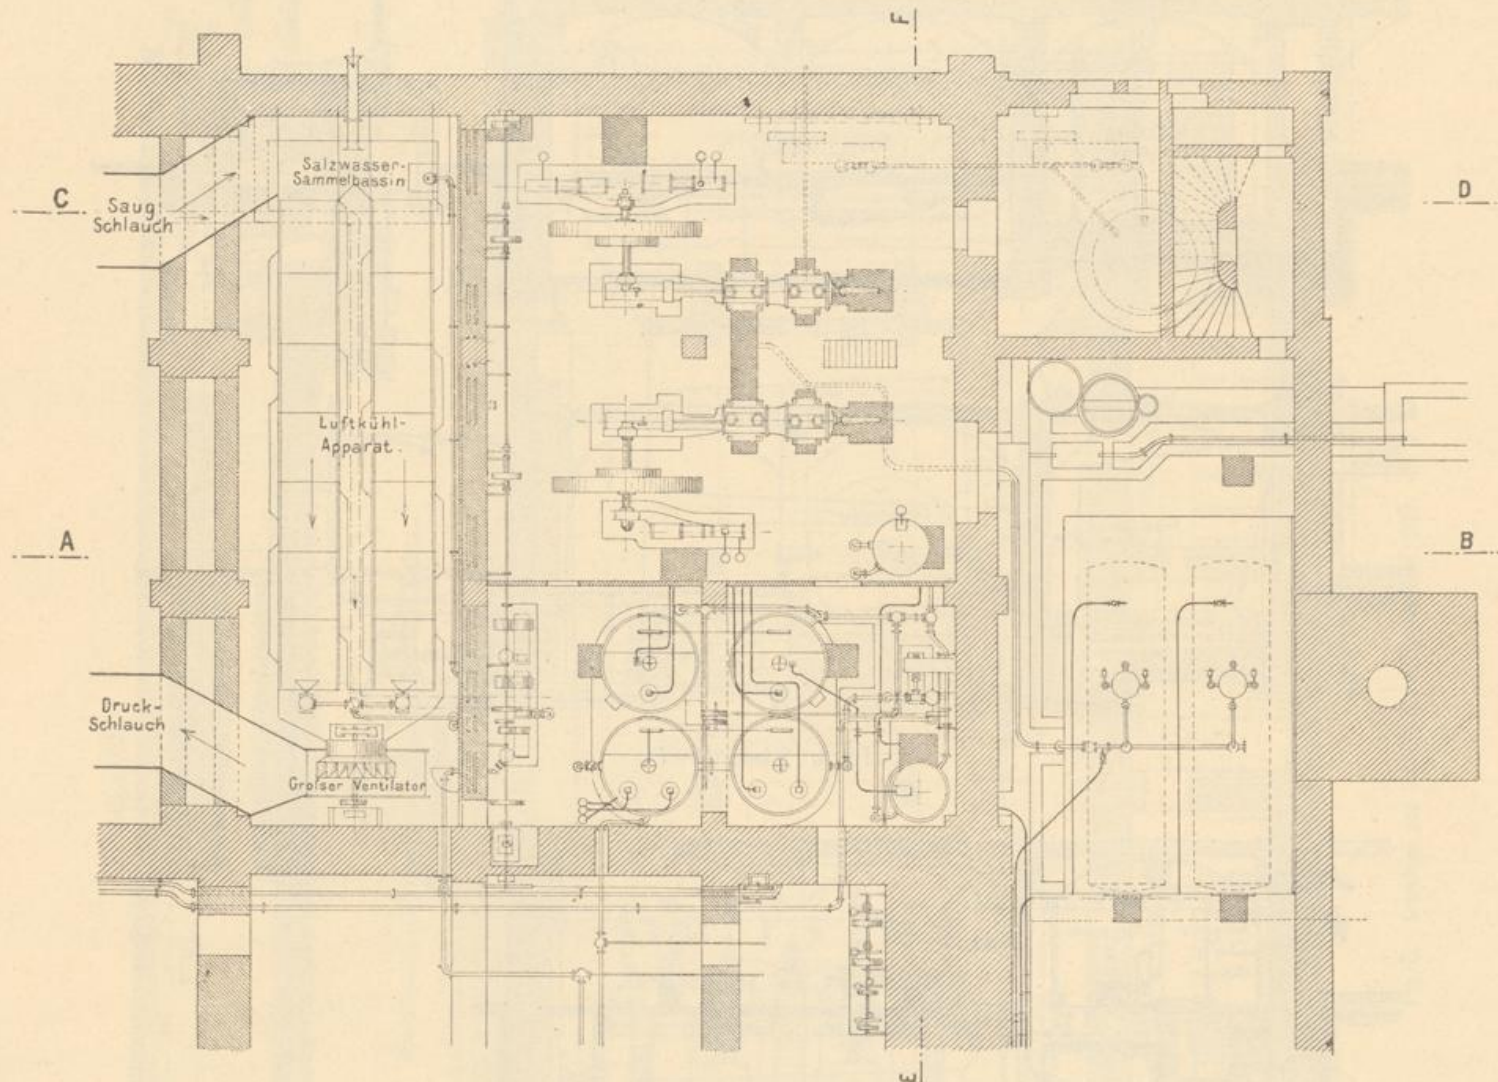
Grundriss der Maschinen- und Kühlanlage. 1:200.
